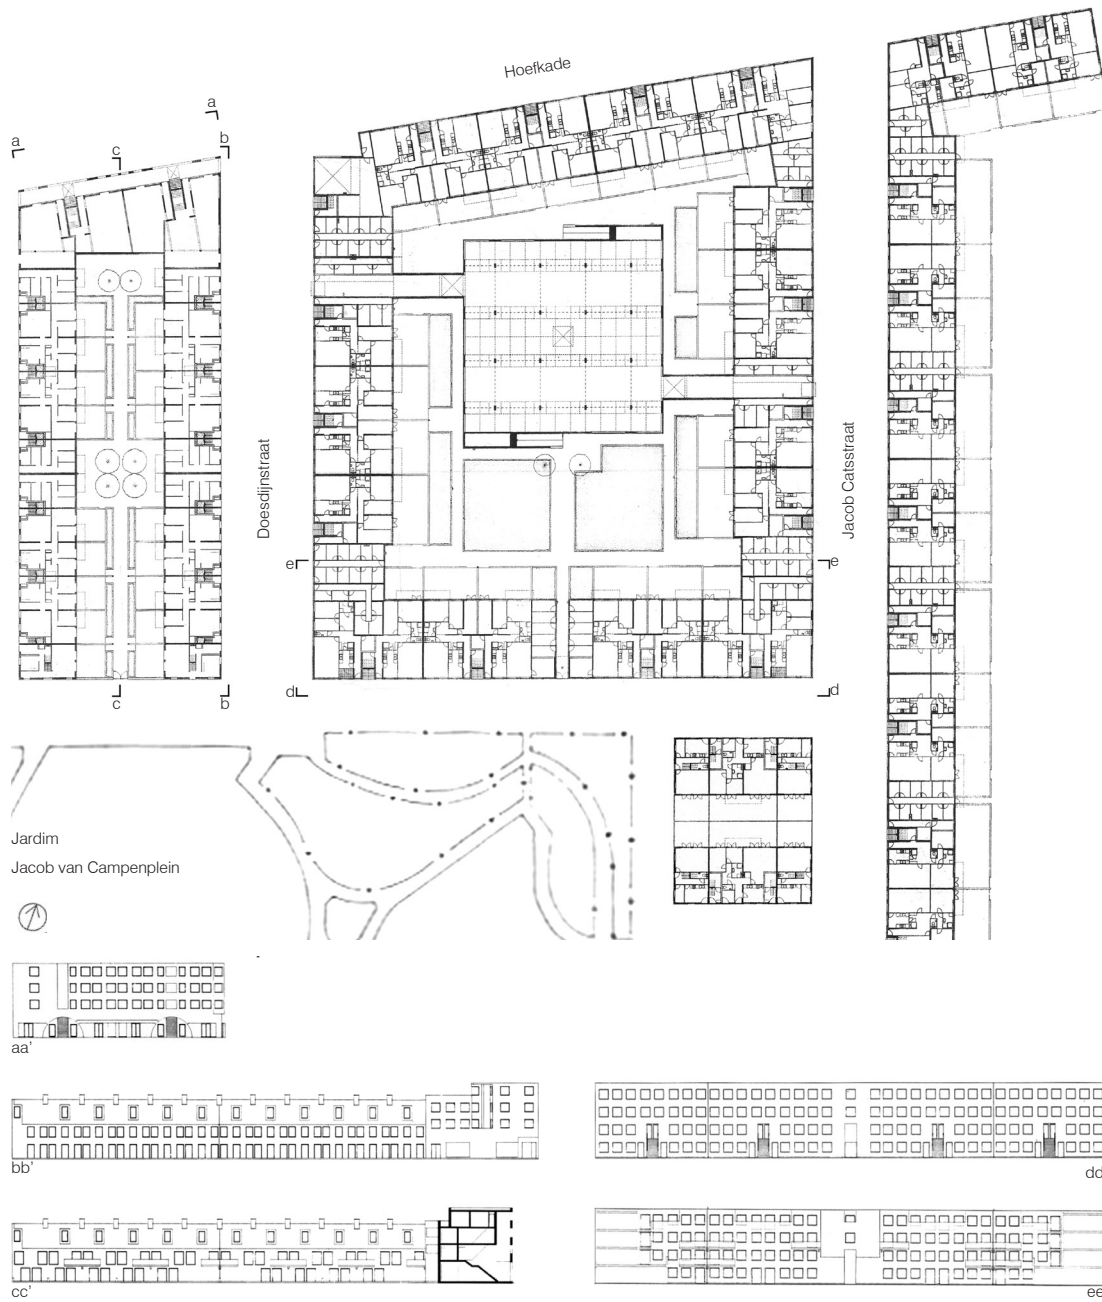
Planta do nível térreo e secções dos blocos para Doedijnstraat, Álvaro Siza.
